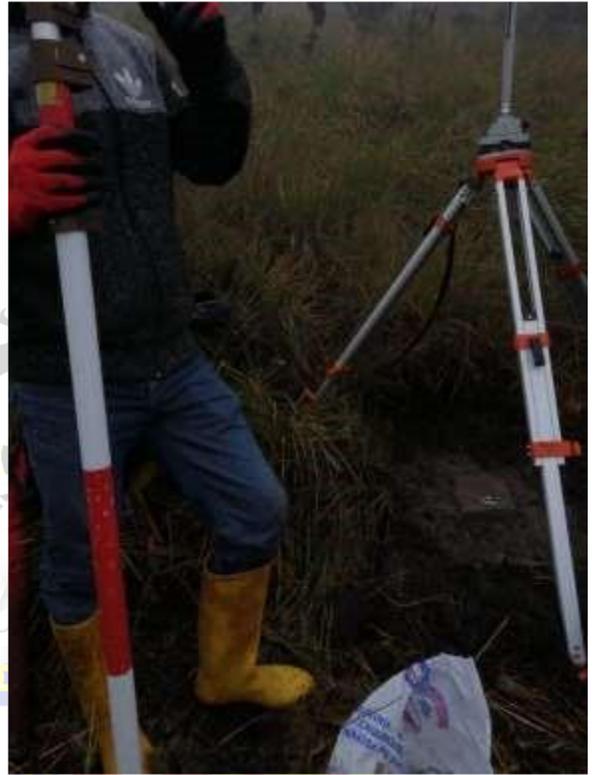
Base y Rover inicio de levantamiento. Fuente: Propia
